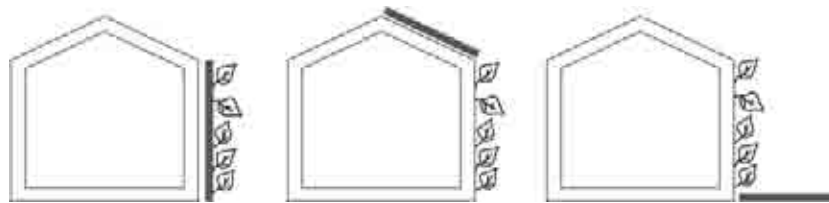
Collocazione del suolo rispetto alla parete verde: in facciata, in copertura, a terra.
